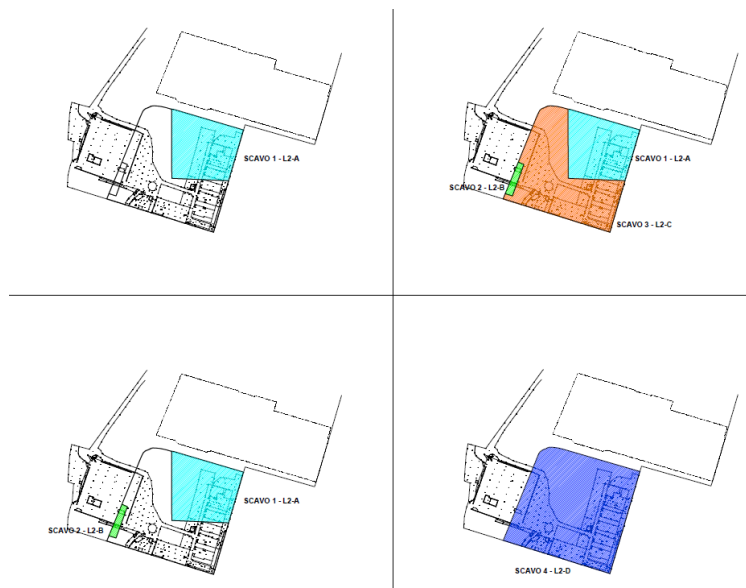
Tavola T5-B, Planimetria sequenza scavi Lotto 2
